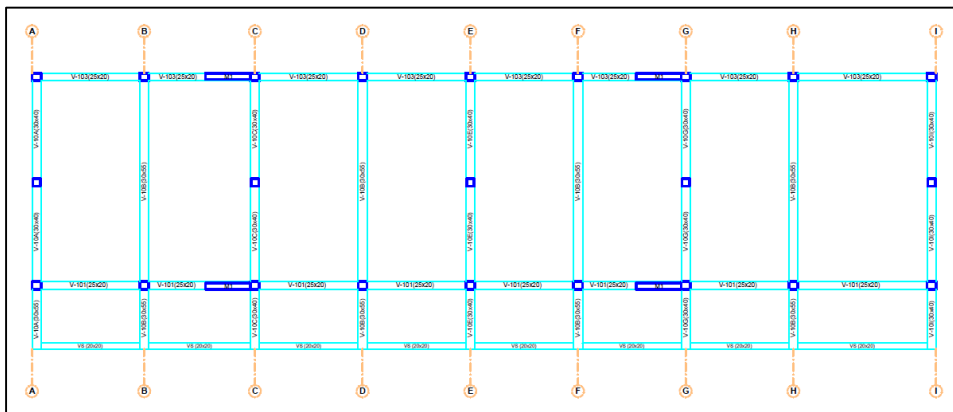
Plano de estructuración con muros de corte propuestos del Módulo A
